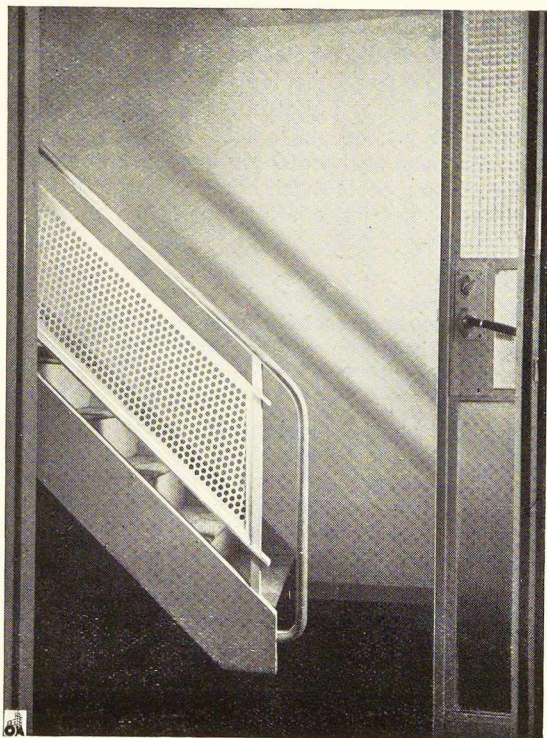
Escalier en tôle entièrement préfabriqué. Noter la rampe exécutée en tôle perforée.
